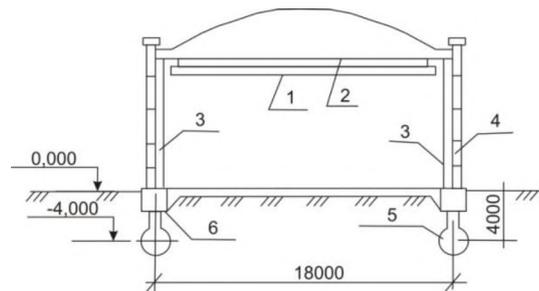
Разрез механической мастерской конвертерного цеха: 1 — подвесной кран-балка; 2 — стропильная железобетонная ферма; 3 — колонна; 4 — стеновая панель; 5 — камуфлетная свая; 6 — монолитный железобетонный стакан
